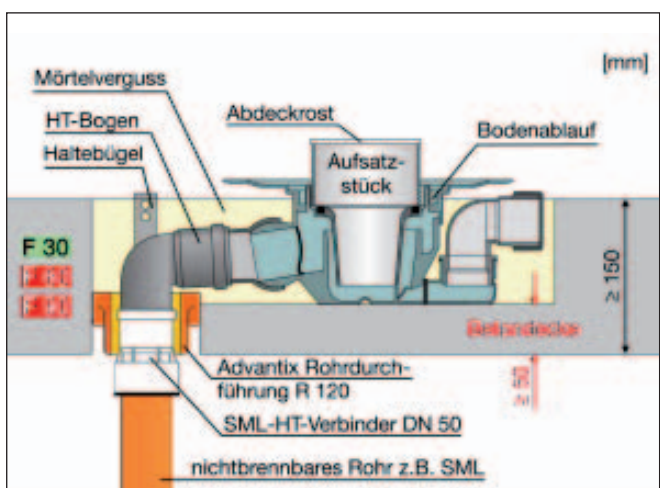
Advantix Rohrdurchführung R 120 in Kombination mit einem in der Decke eingebauten Bodenablauf und angeschlossenem Gussrohr.
